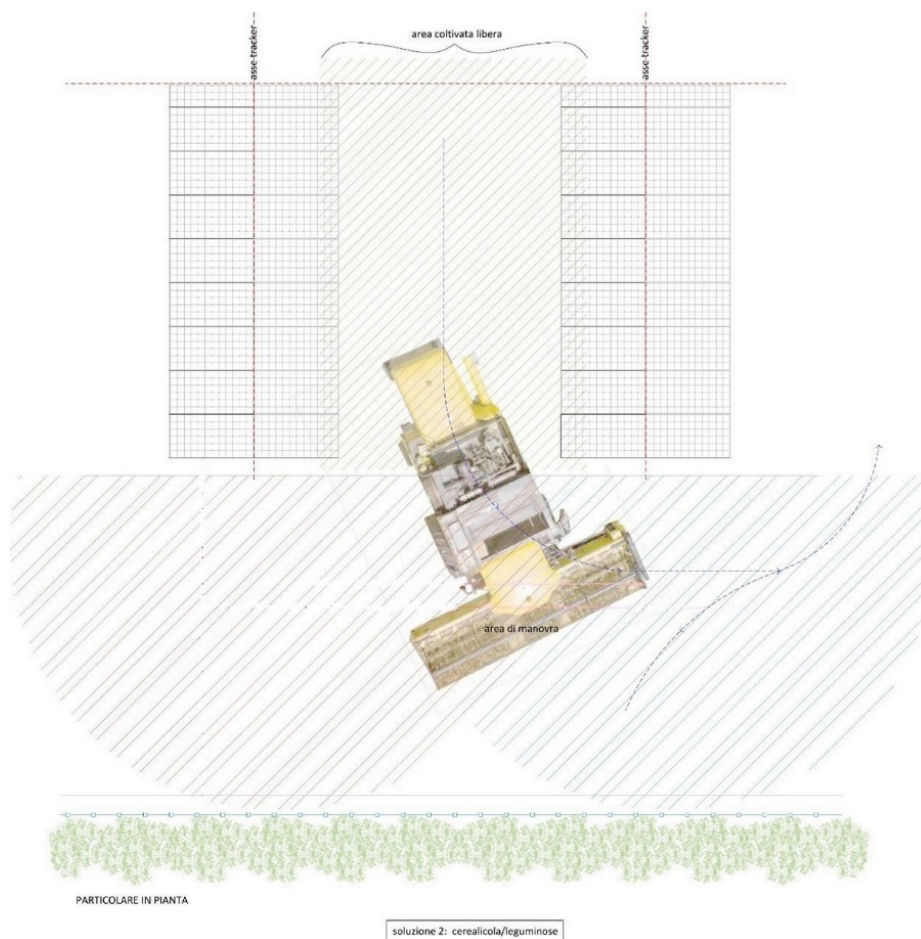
Schema di movimentazione e manovra da attuarsi nelle fasce di viabilità perimetrale
